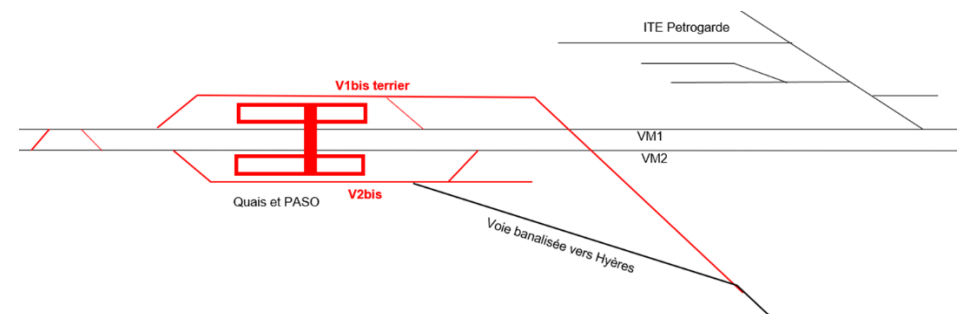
Plan de voie projeté (source : Egis, 2021)
